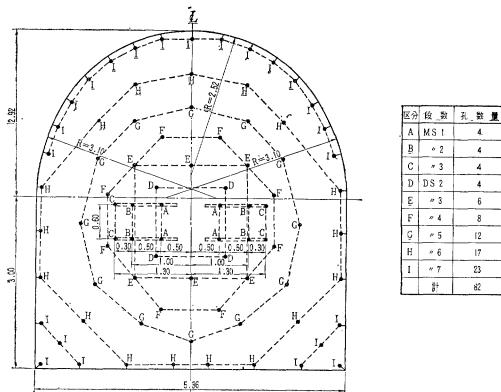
(c) 国鉄単線トンネル全断面掘削せん孔配置図
